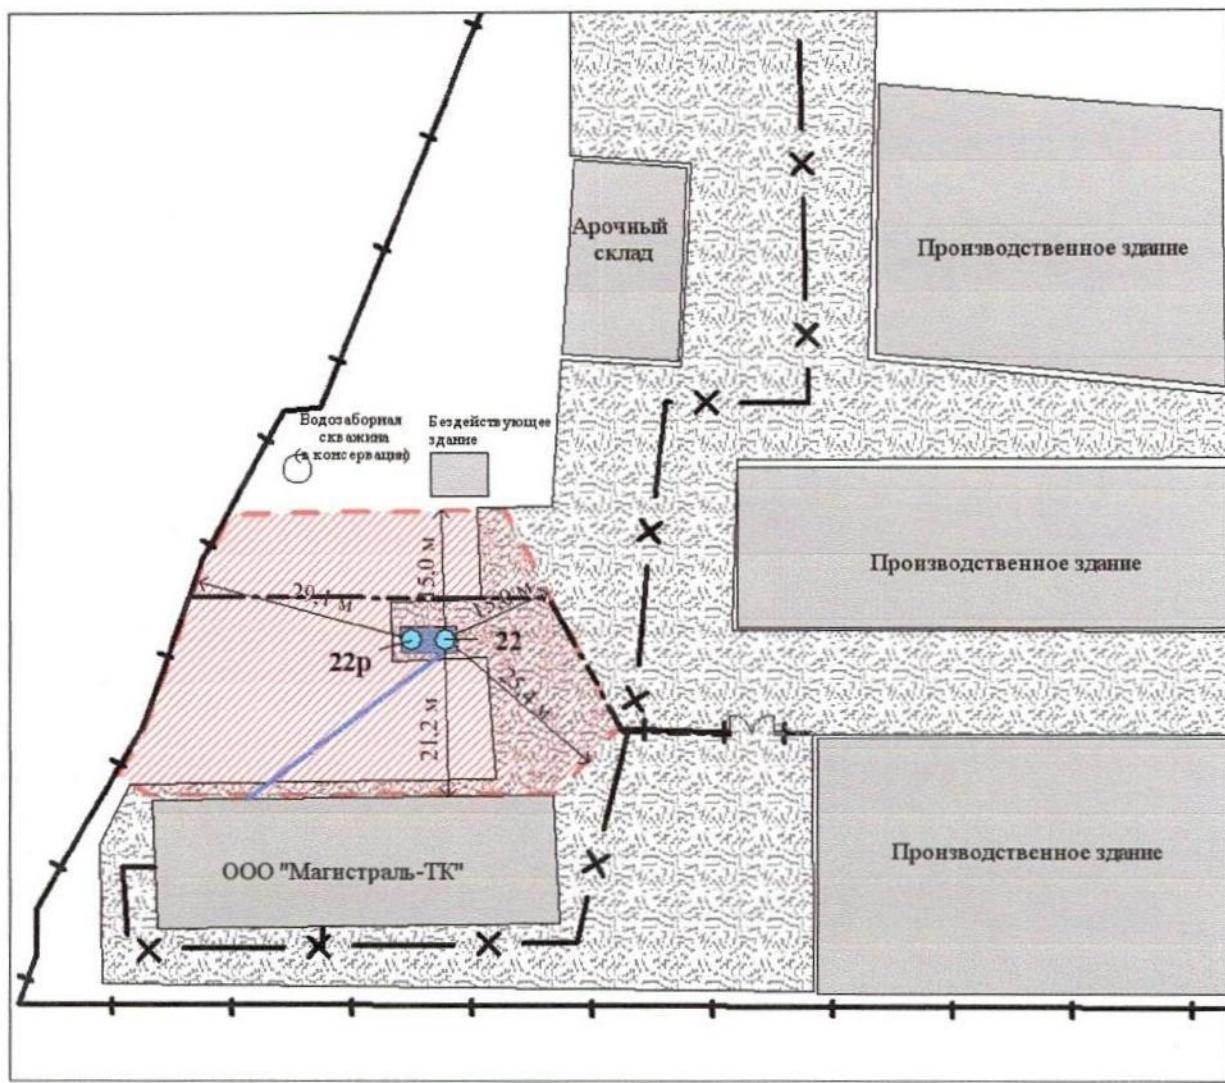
Ситуационный план с границами 1-го пояса ЗСО
